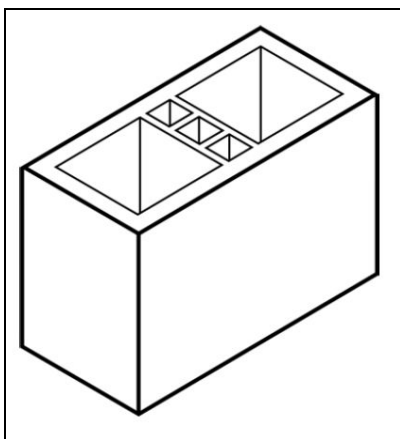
bloco cerâmico estrutural de paredes maciças externamente e vazadas internamente
